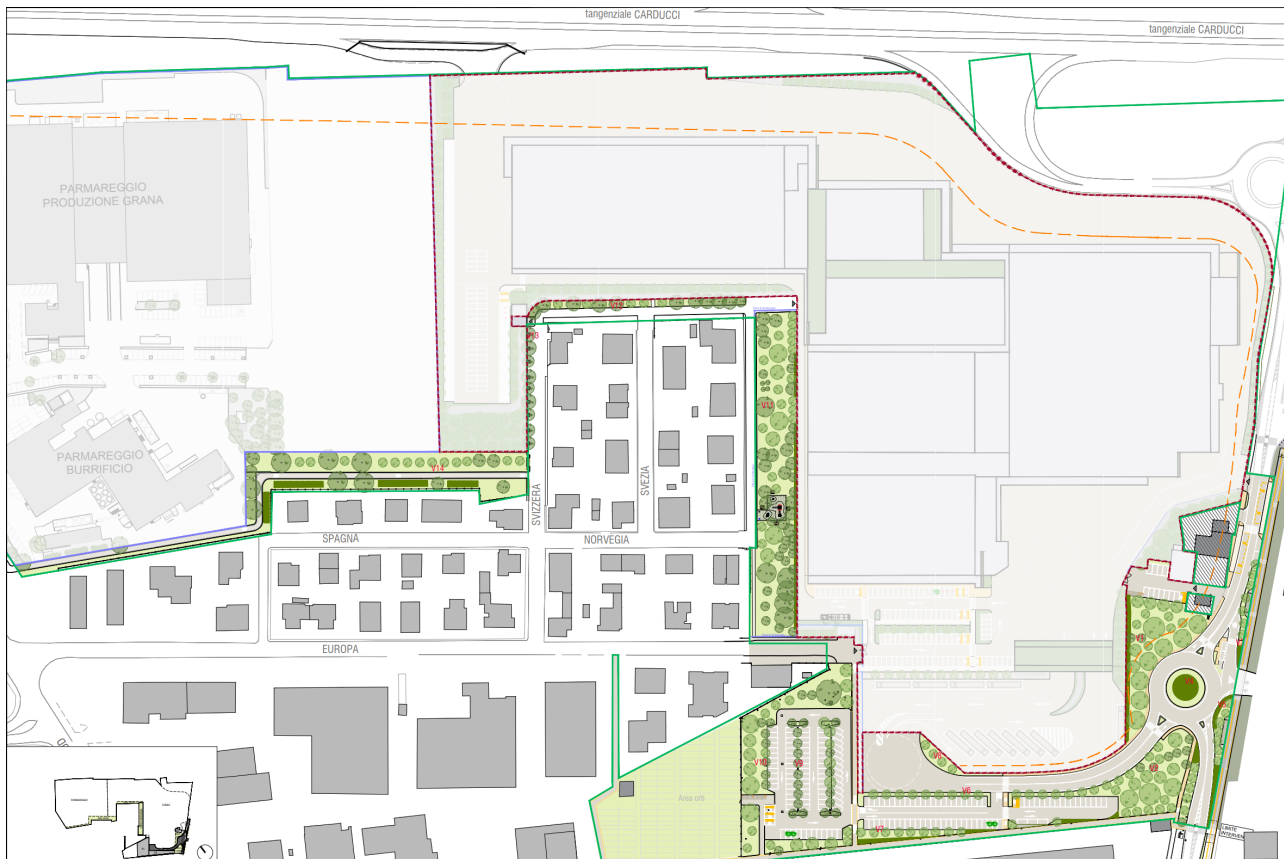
Planimetria della sistemazione del verde nel lotto oggetto di intervento
